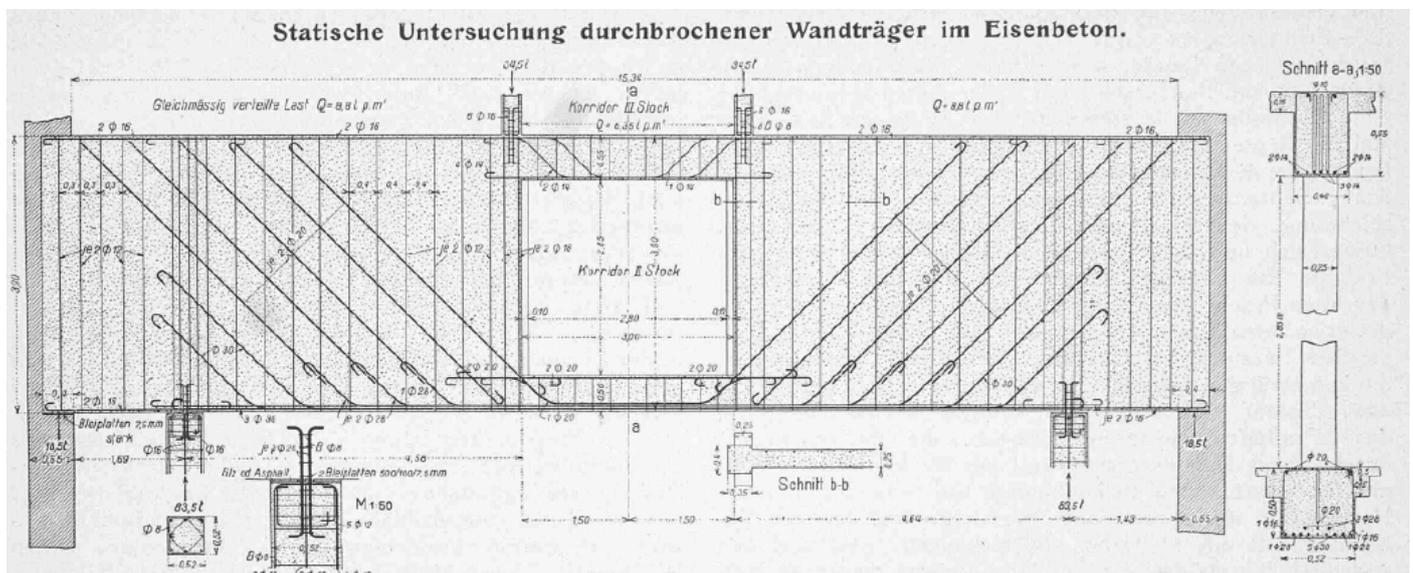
Disposition du ferrailage d'une poutre en forme de mur avec une ouverture de [2].
